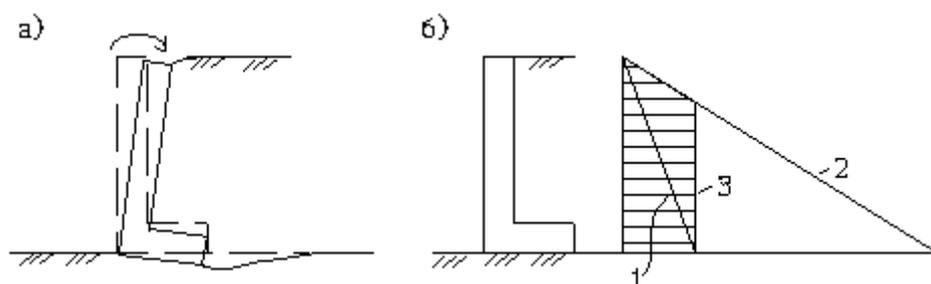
Влияние навала высокой стены на грунт на давление на нее:
